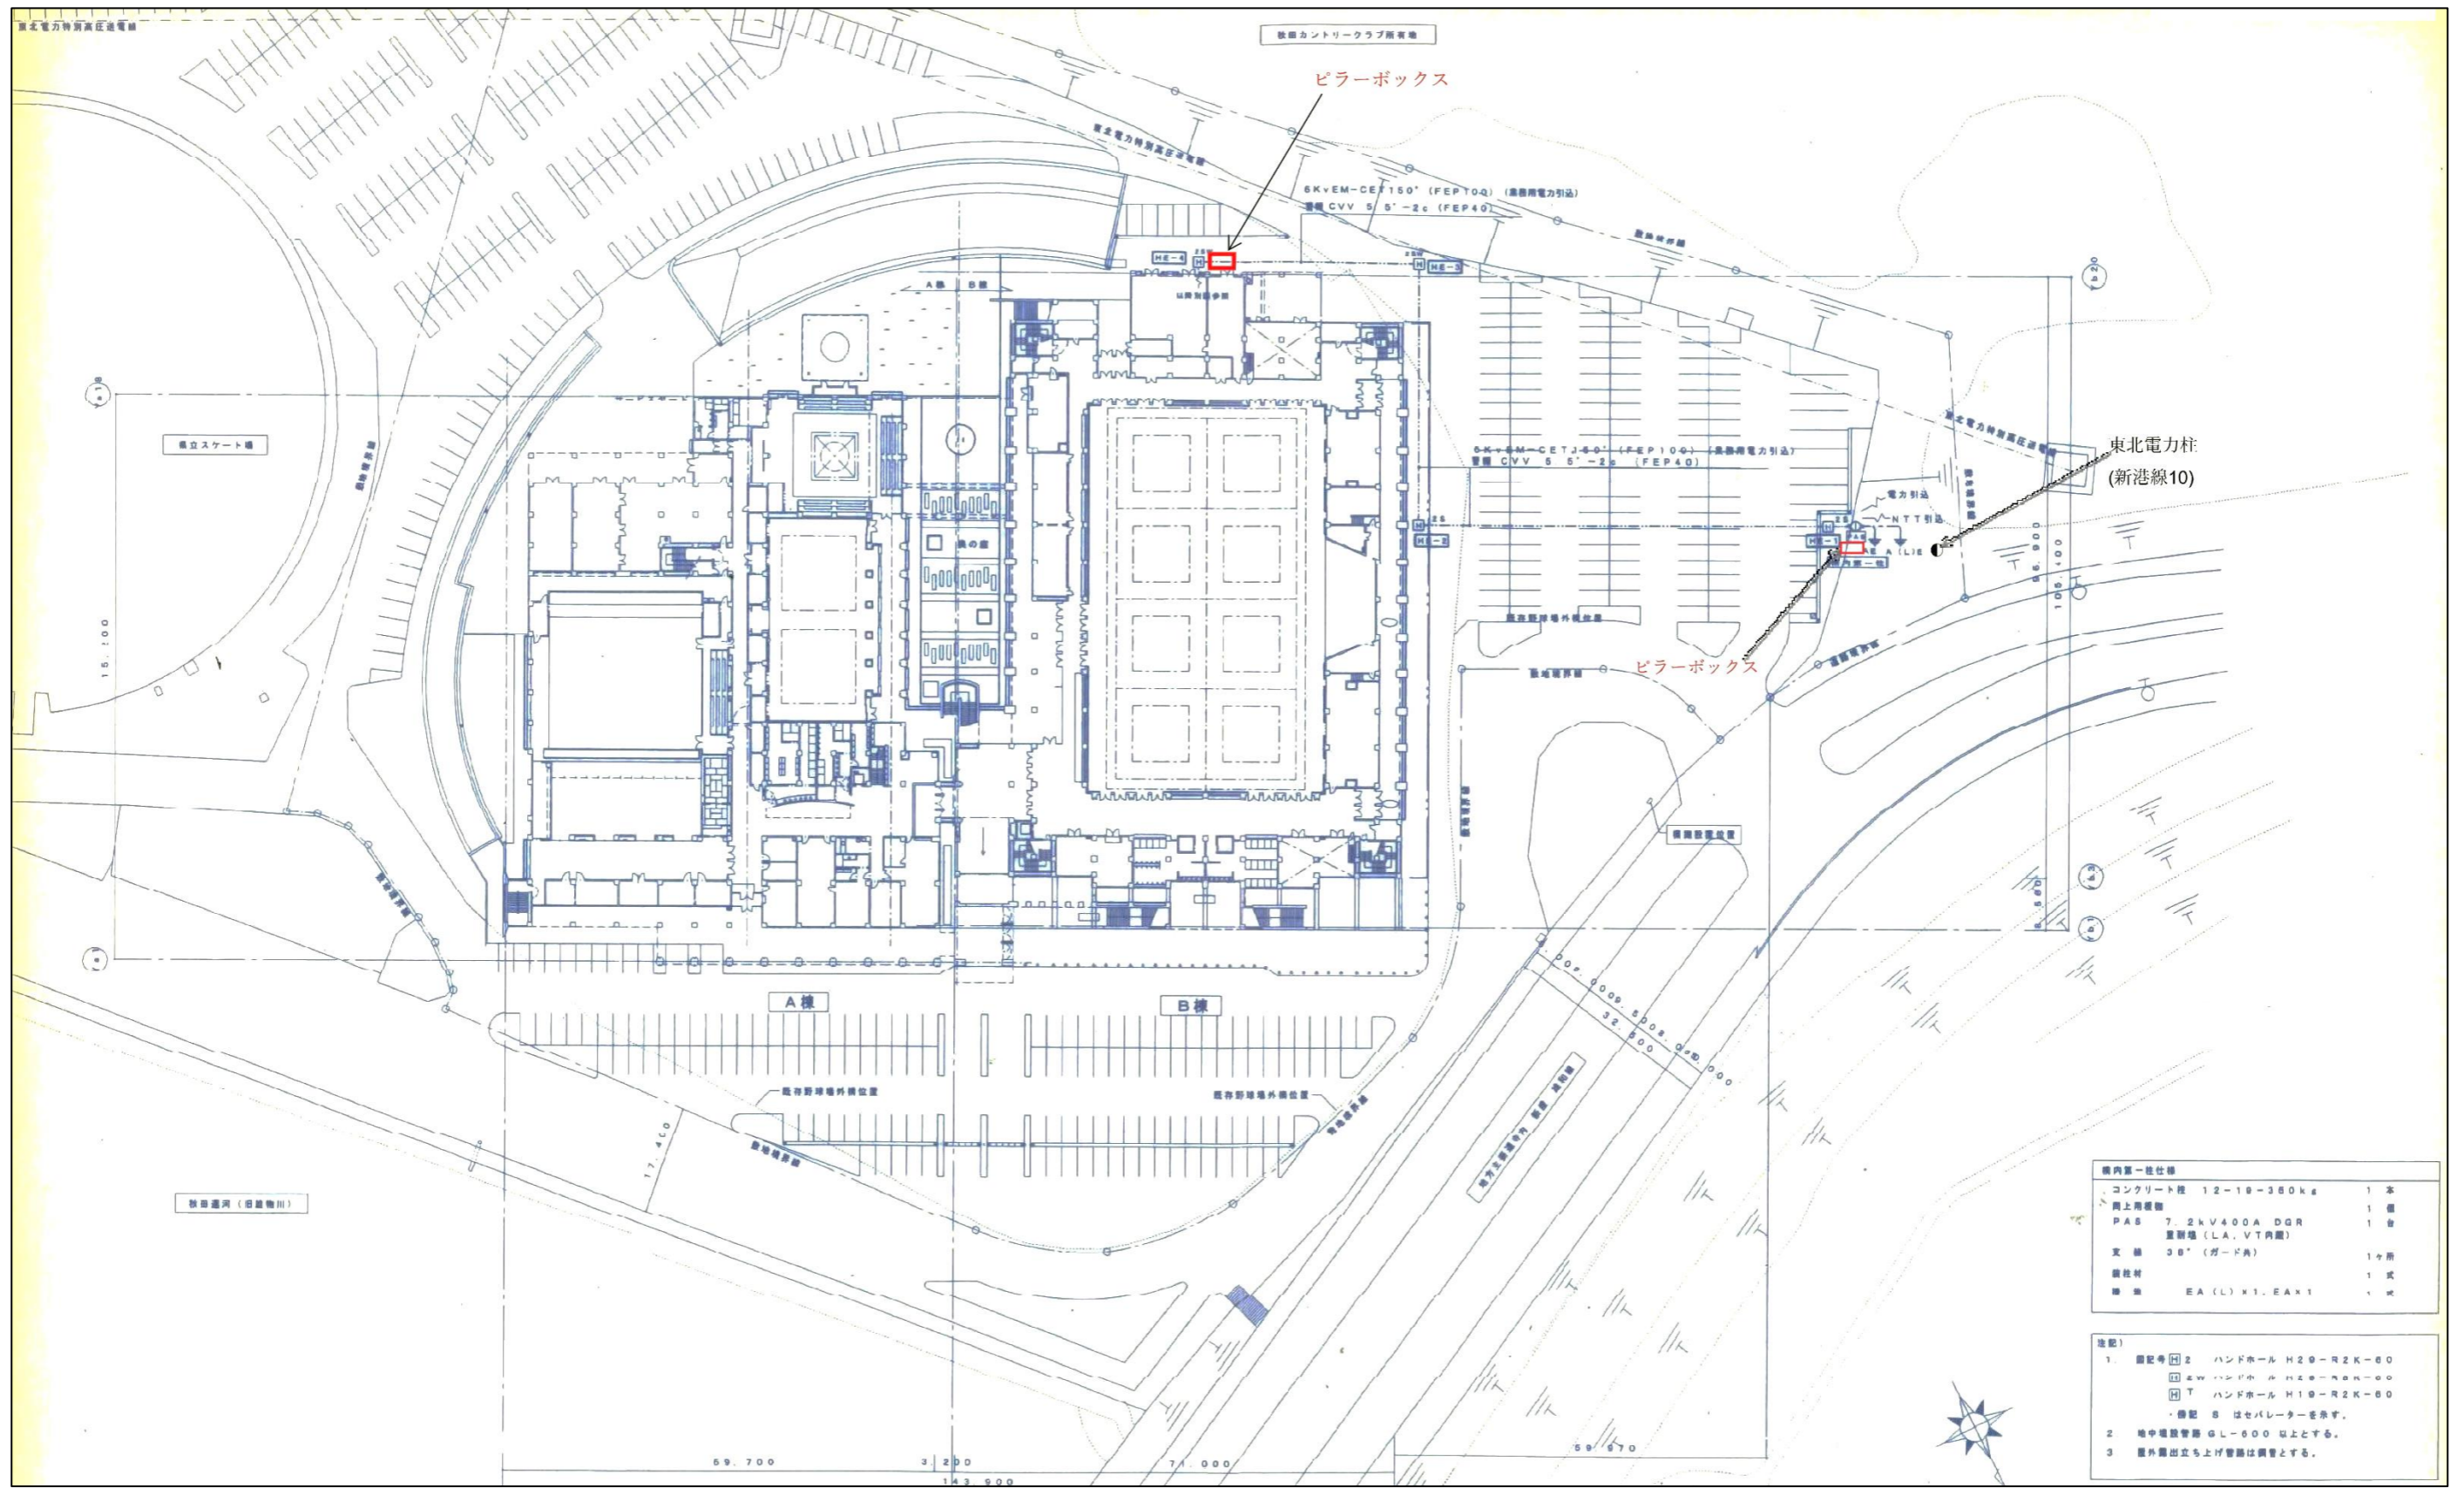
県立武道館平面図 (ピラーボックス設置位置案)
